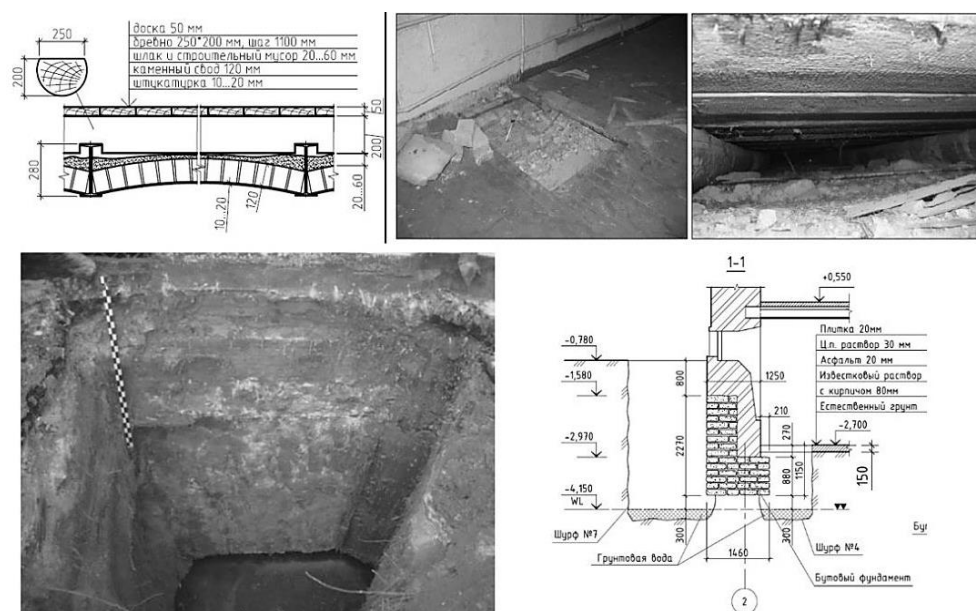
Характерные вскрытые зондажи (а) в перекрытии и шурфы (б) у фундаментов
